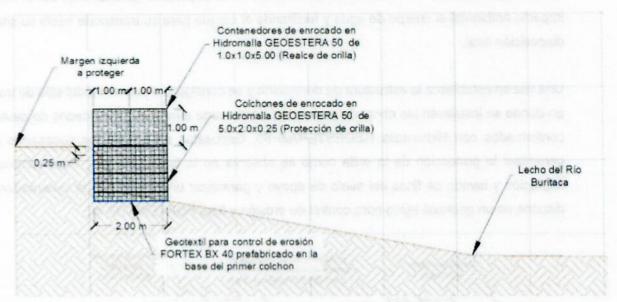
Estructura propuesta sector 2 Alternativa 1 (Sección 0+520)
